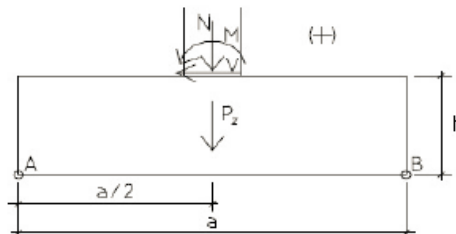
Esquema de cargas sobre la zapata a dimensionar.
